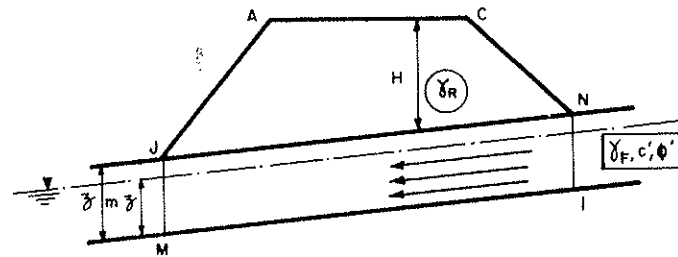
Esquema de cálculo de Pilot y Kacmaz, 1968.
